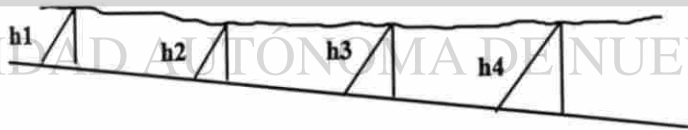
Perfil de la tubería de drenaje y el terreno
